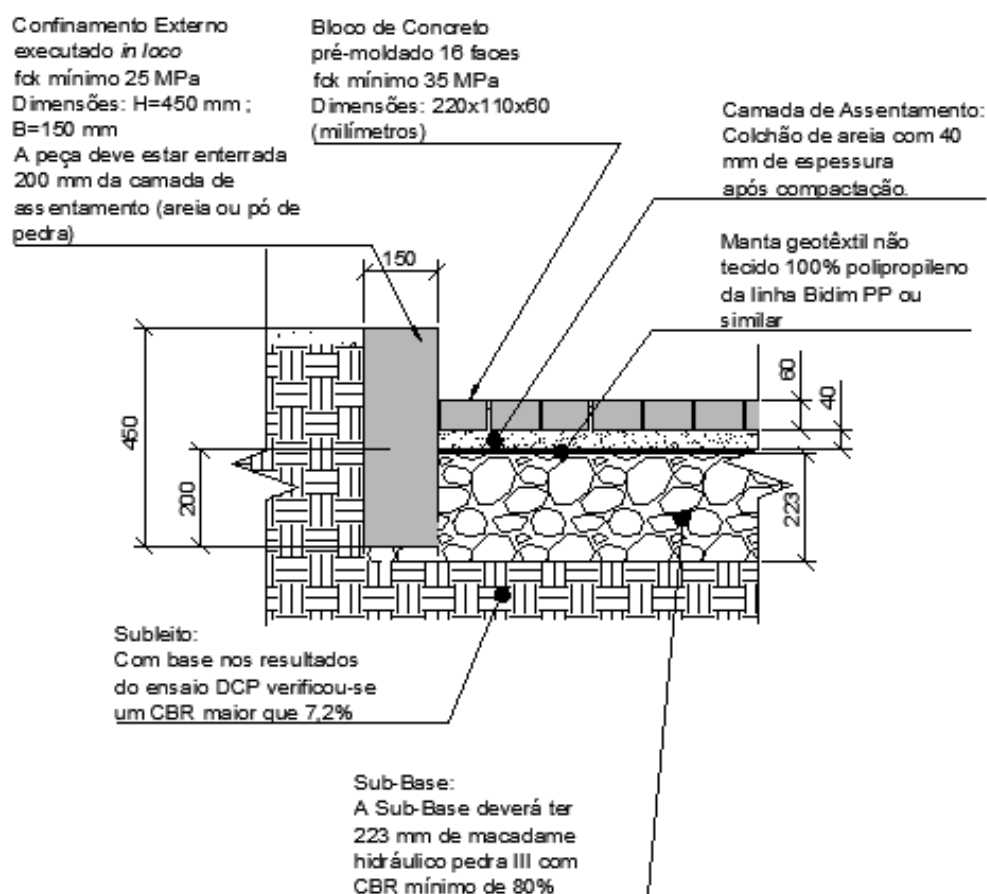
Estrutura esquemática pelo dimensionamento hidráulico
